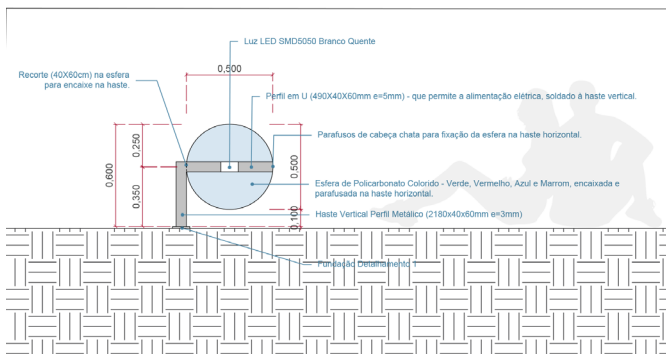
Detalhamento PIN baixo / Fonte: Aatoria do grupo.
